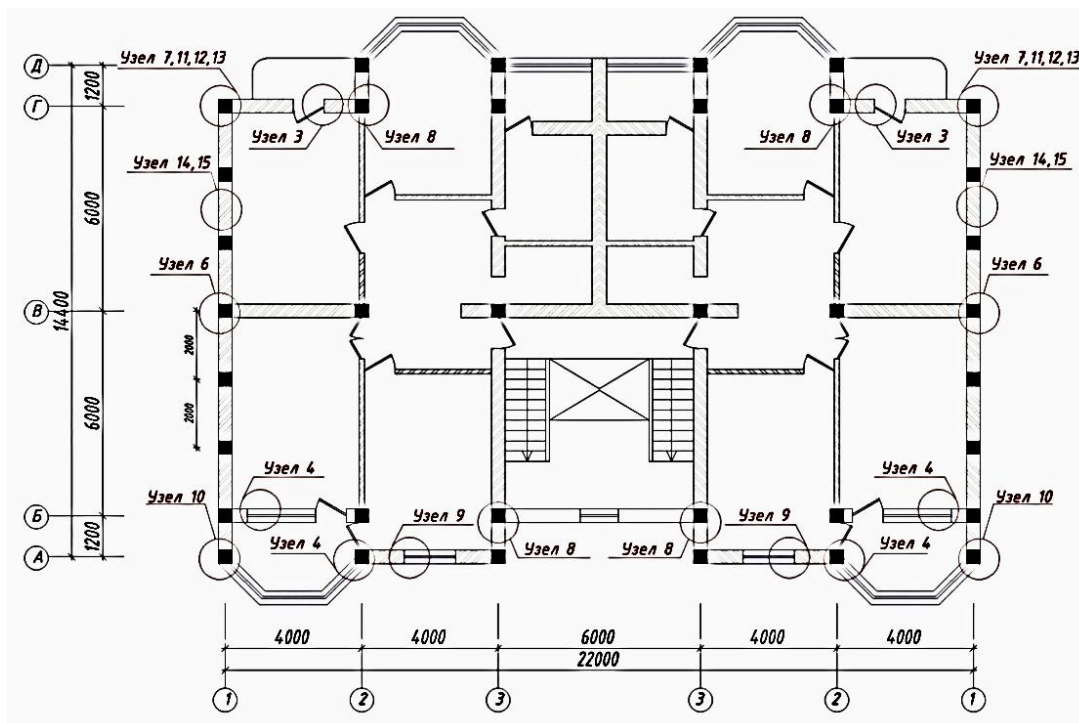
План типового этажа жилого дома с обозначенными узлами с тепловыми мостиками
